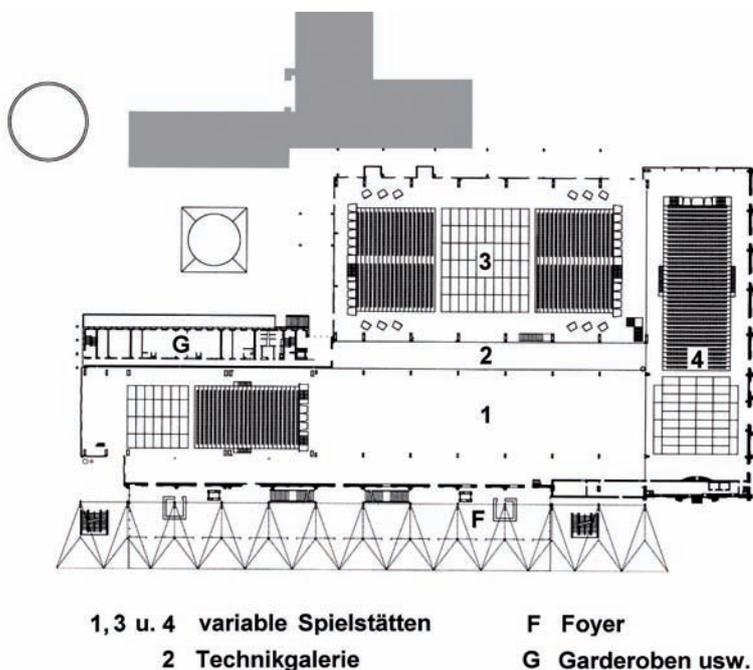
Bochum, Grundriss der „Jahrhunderthalle“ nach dem Umbau für die Ruhrtriennale
